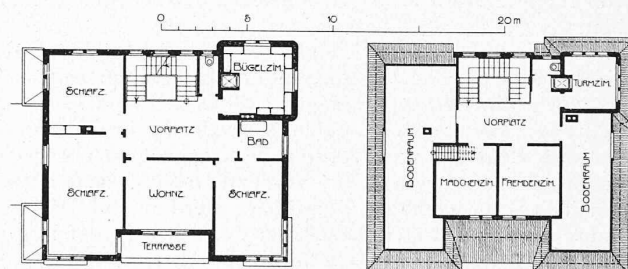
bis 3. Lageplan und Grundrisse (1:400) der Villa Altermatt. — Architekten Kaufmann & Freymuth, Frauenfeld.
